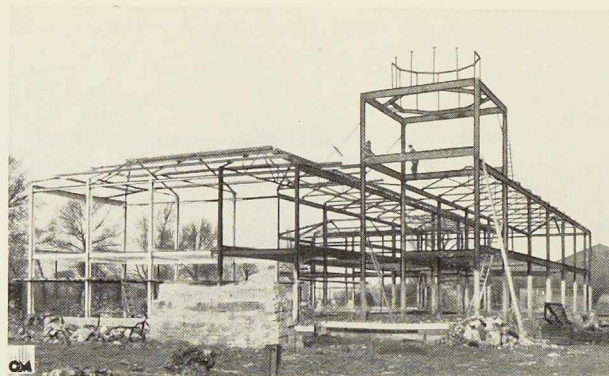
Ossature métallique du bâtiment administratif de l'usine Murex à Waltham Cross.
